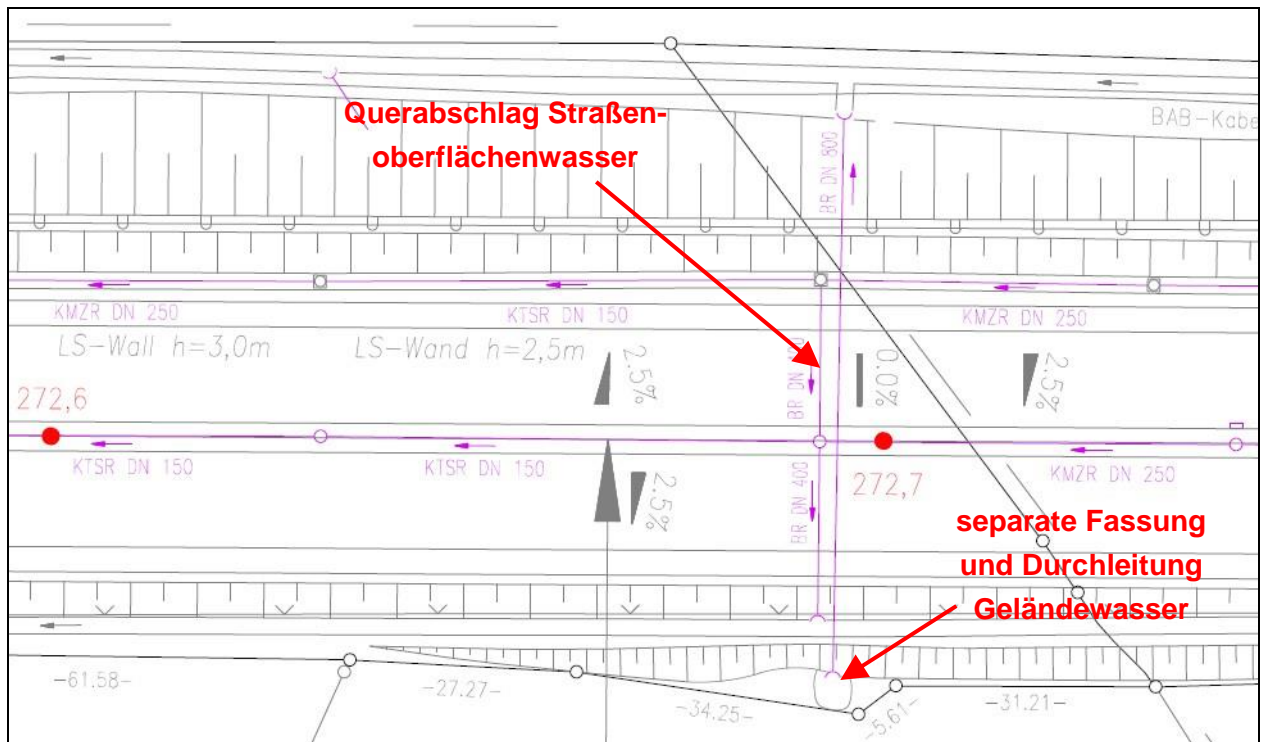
Auszug Bestandsplan BAB A9 (Norden links) mit Querabschlag (DN 400) des Straßenoberflächenwassers in westliche Mulde am Dammfuß sowie separate Fassung und Durchleitung des Geländewassers (DN 800)
